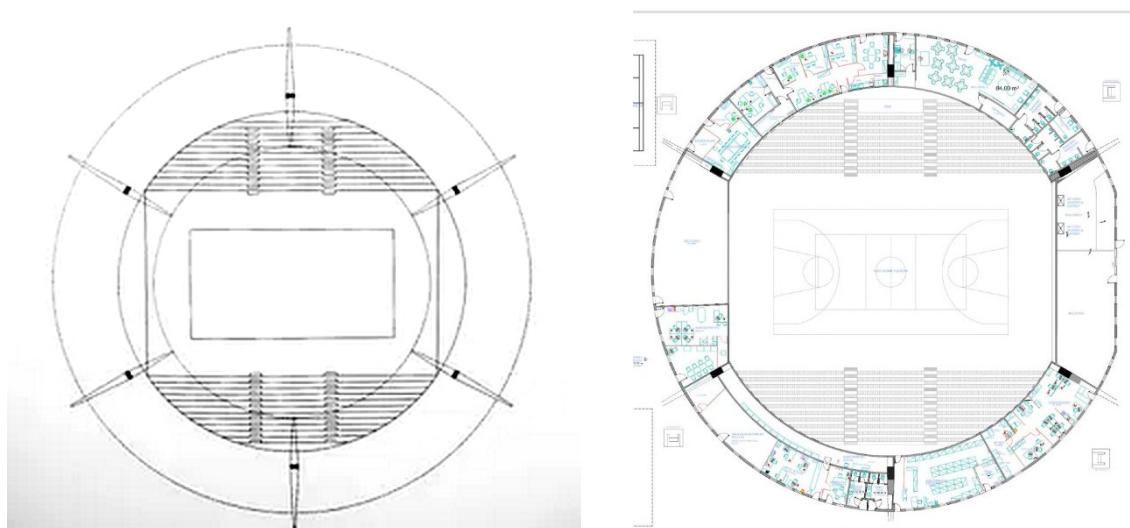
/15 - Planta original e Planta atual do ginásio após intervenções Fonte: Archdaily/ Departamento de Cultura do Ginásio Atlético Paulistano
